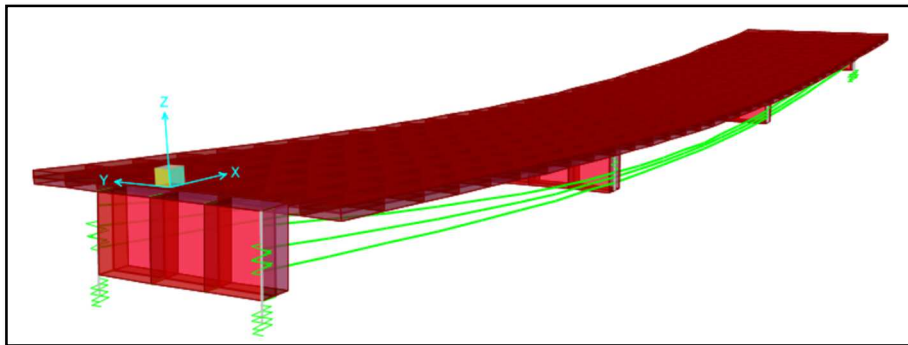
Imagen del puente viga post tensado L=32 m analizado.
